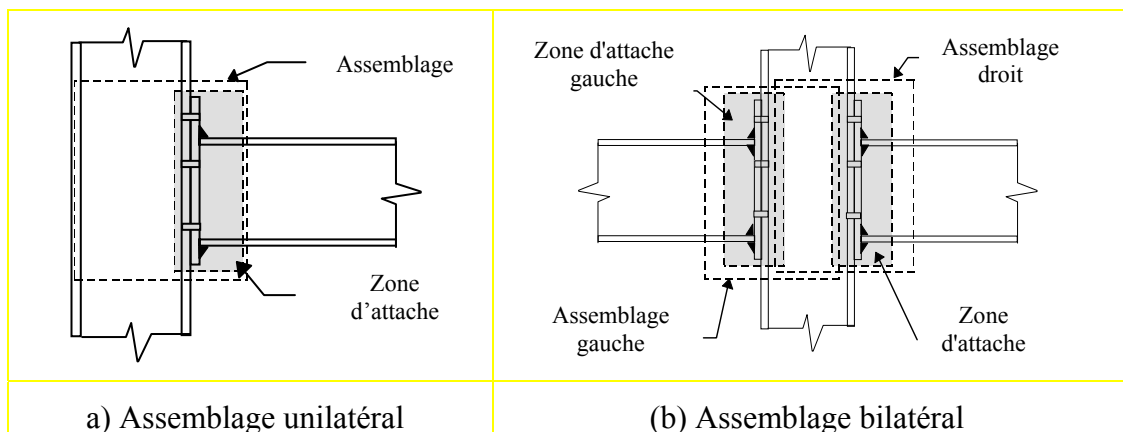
Définition de la zone d'attache et de l'assemblage (assemblage poteau-poutre)
